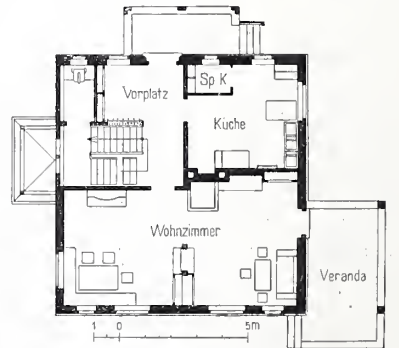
Grundriss vom Erdgeschoss des Hauses von Dr. Finekh. — 1:400.
